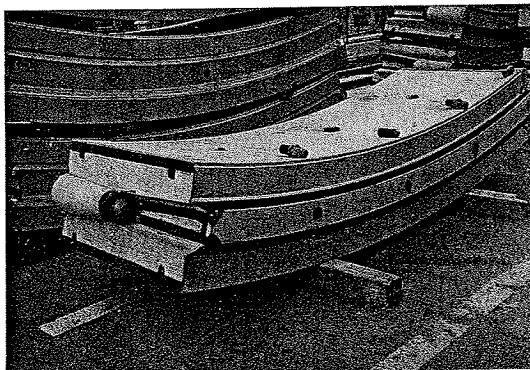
ピン-ホゾ継手鉄筋コンクリートセグメント
